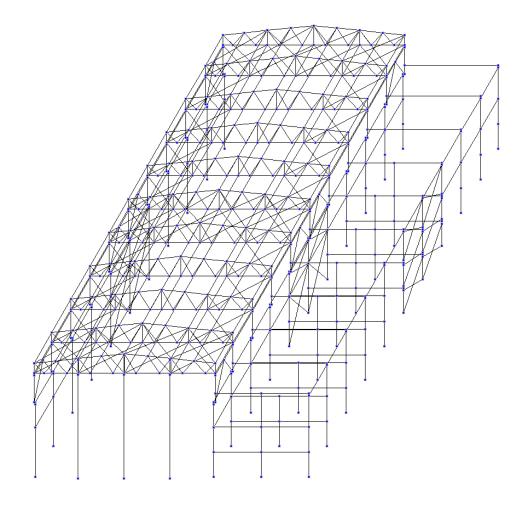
Общий вид расчетной схемы каркаса здания
